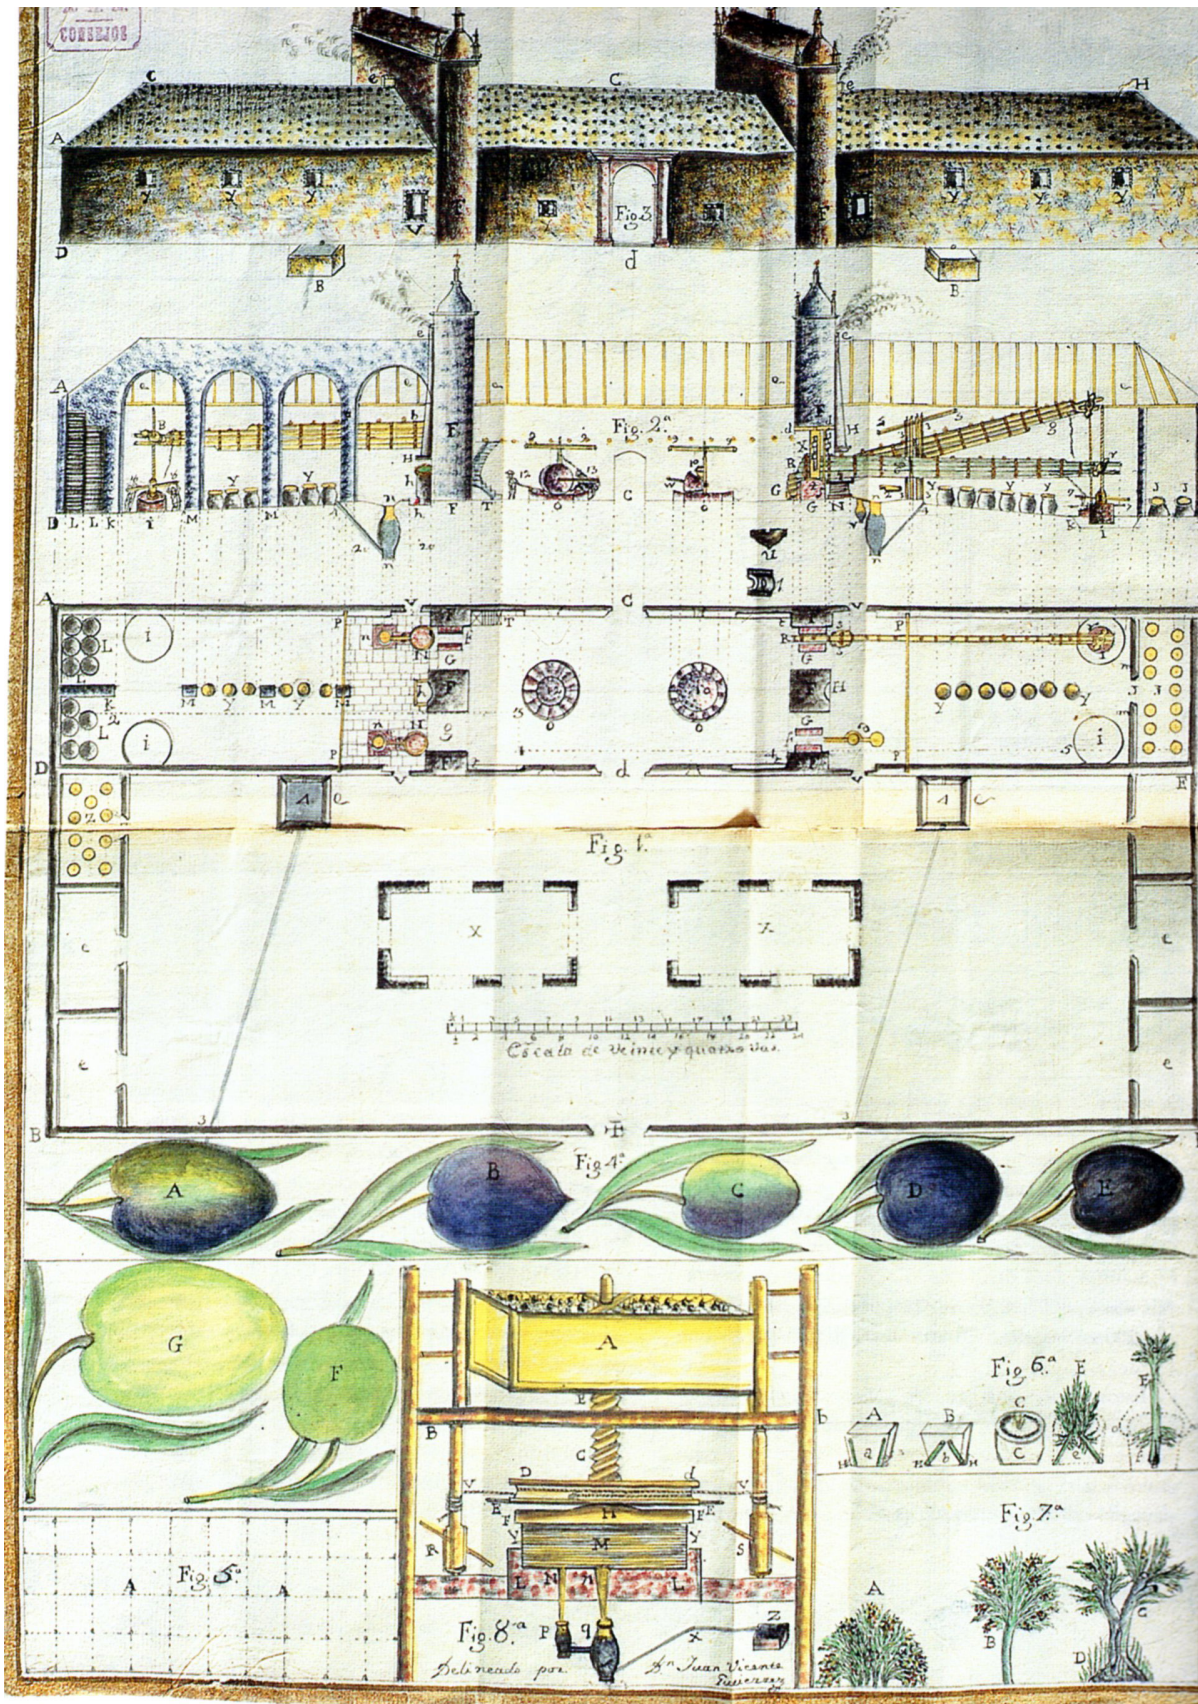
Alzado, sección y planta de un molino de aceite con cuatro prensas de viga en Andalucía, junto con un esquema de una prensa de cabestrante. Archivo Histórico Nacional. Olmedo, 2007, p. 394.
